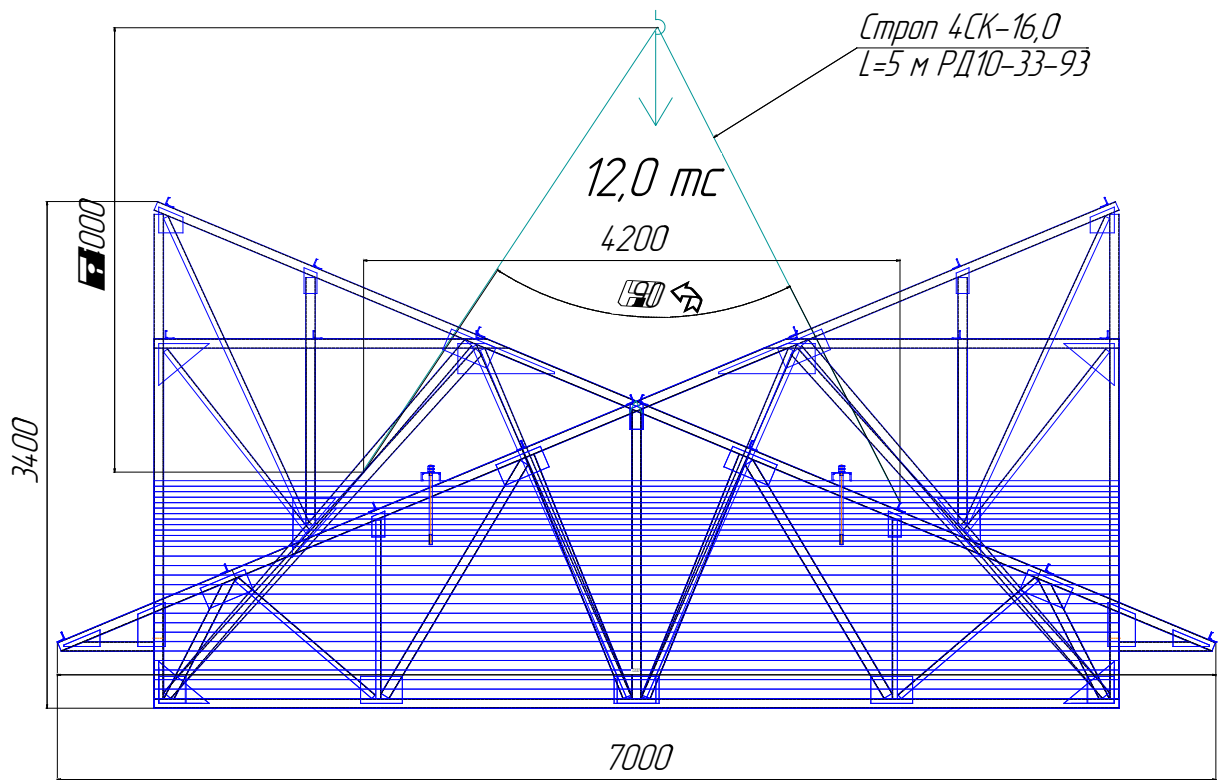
Схема строповки контейнера с металлоконструкциями
